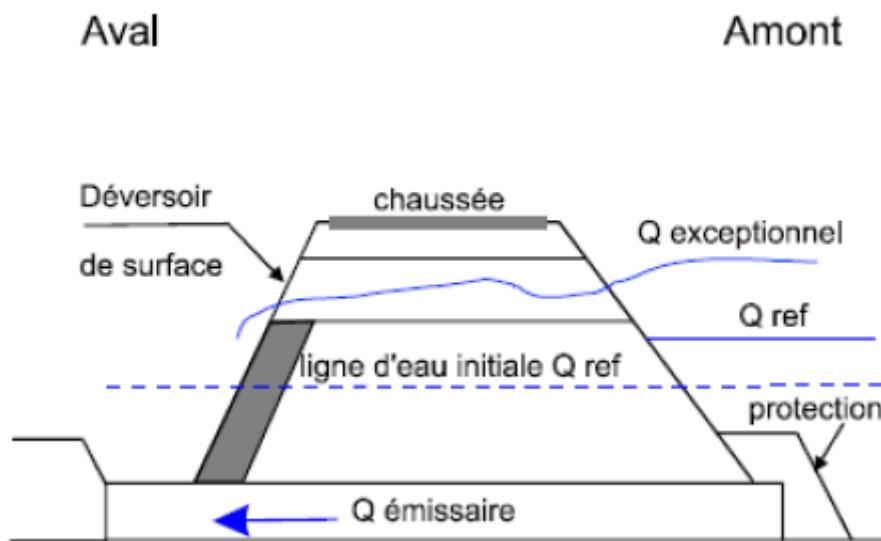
Coupe-type d'un remblai routier conçu comme ouvrage de retenue
